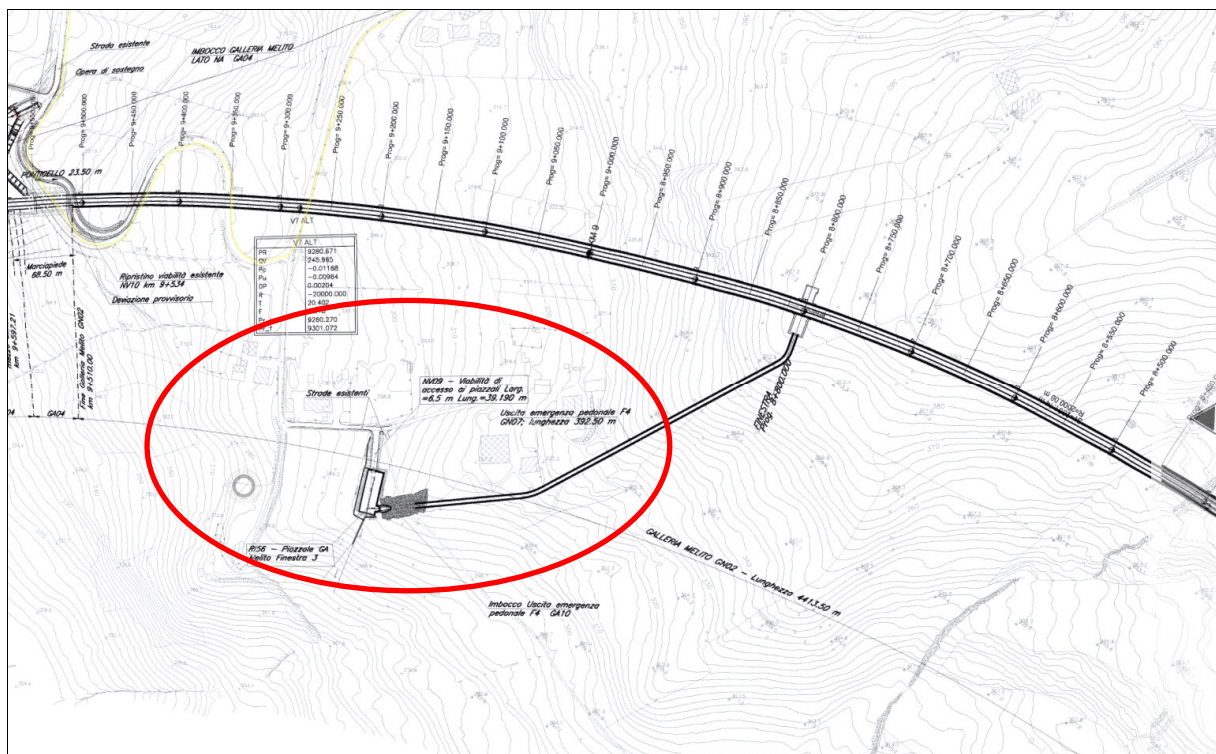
Stralcio planimetrico con l'individuazione dell'intervento
